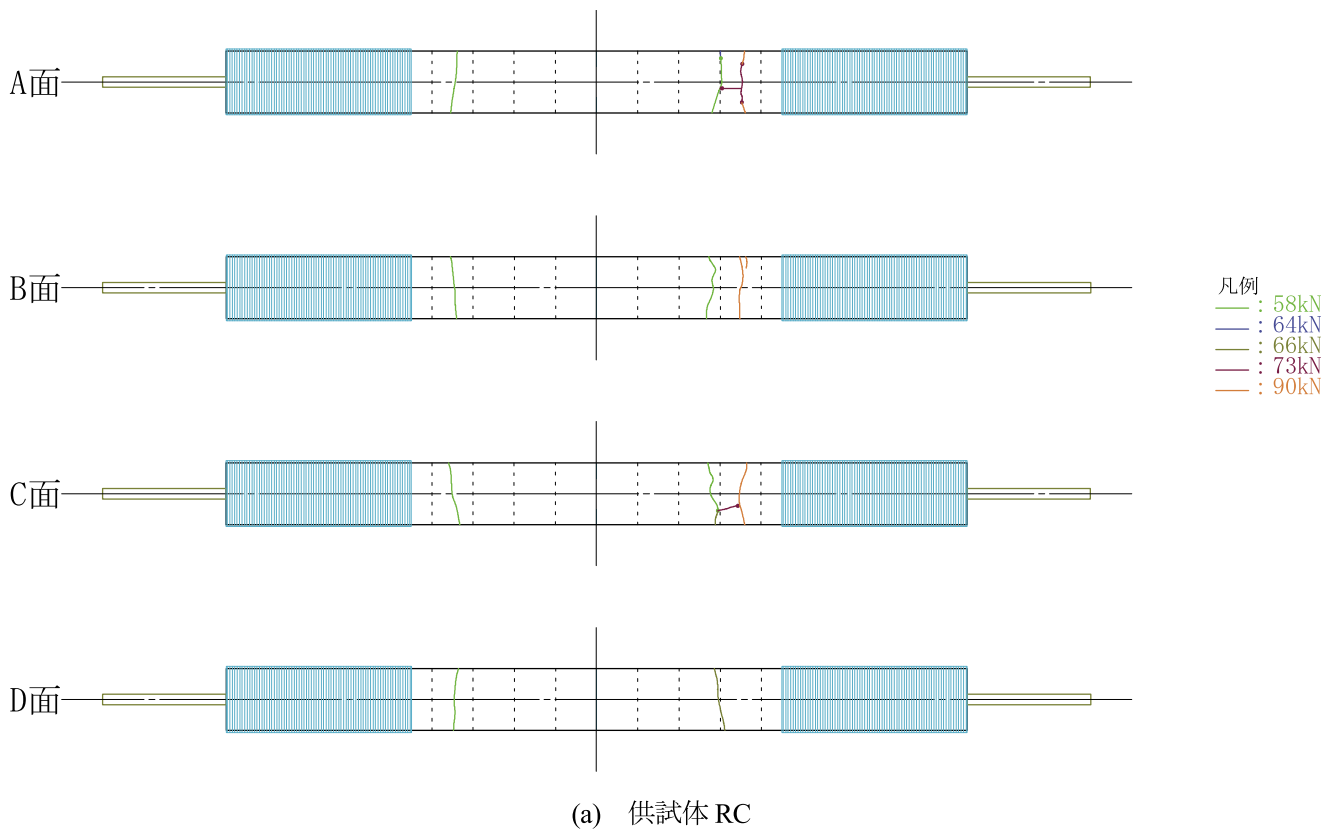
鉄筋降伏時におけるコンクリートのひび割れ発生状況
